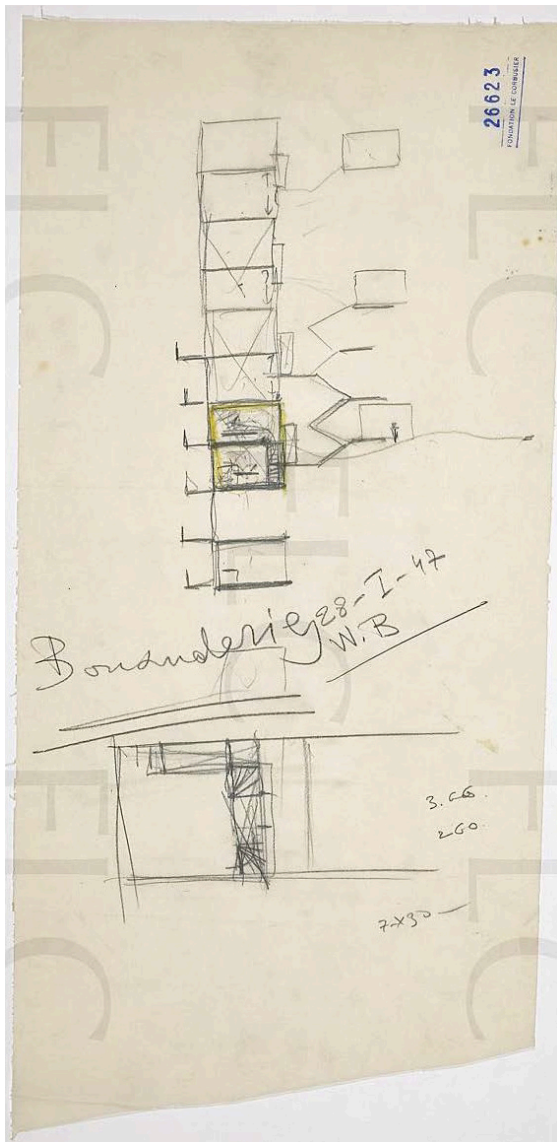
洗濯室, 棟の部分断面図・平面図, FLC26623
